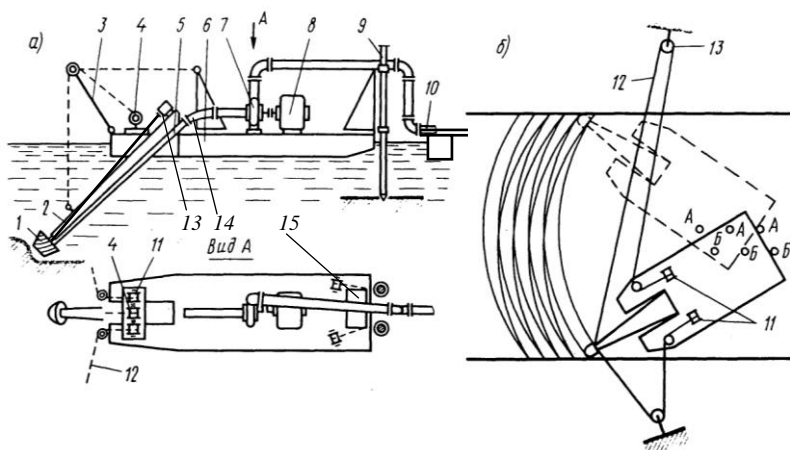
Схема земснаряда: а – вид сбоку и сверху; б – схема свайно-гросового папильонирования.
